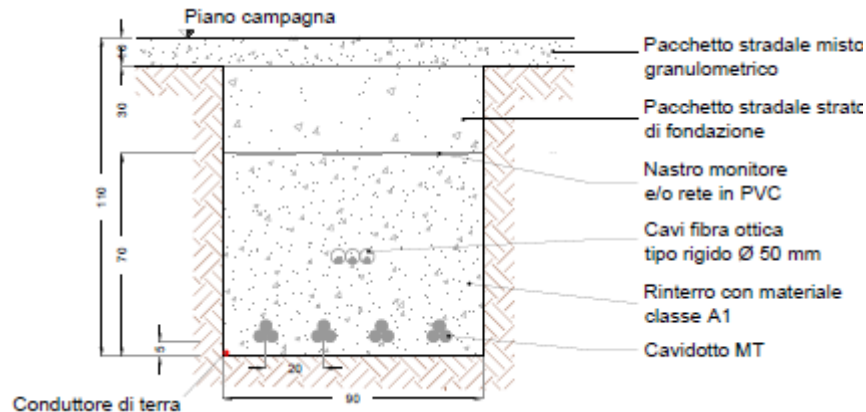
Sezione tipo su strade sterrate Cavidotto 30 kV
